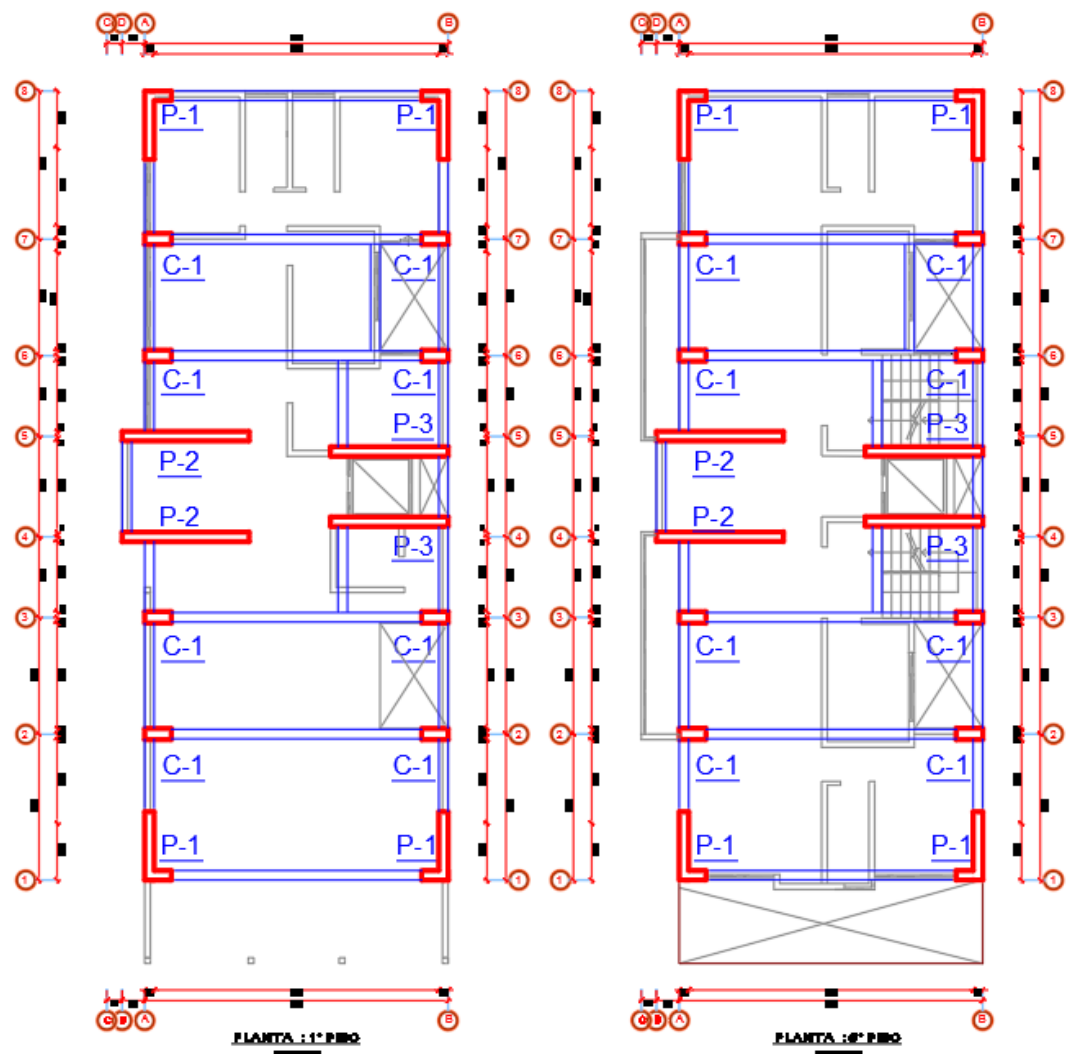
Segunda Estructuración de multifamiliar (Elaboración propia)
